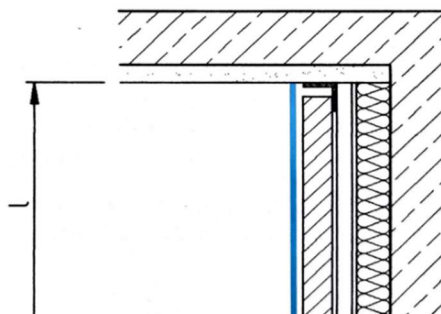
Coupe horizontale sur façade ; angle rentrant - céramique / enduit
